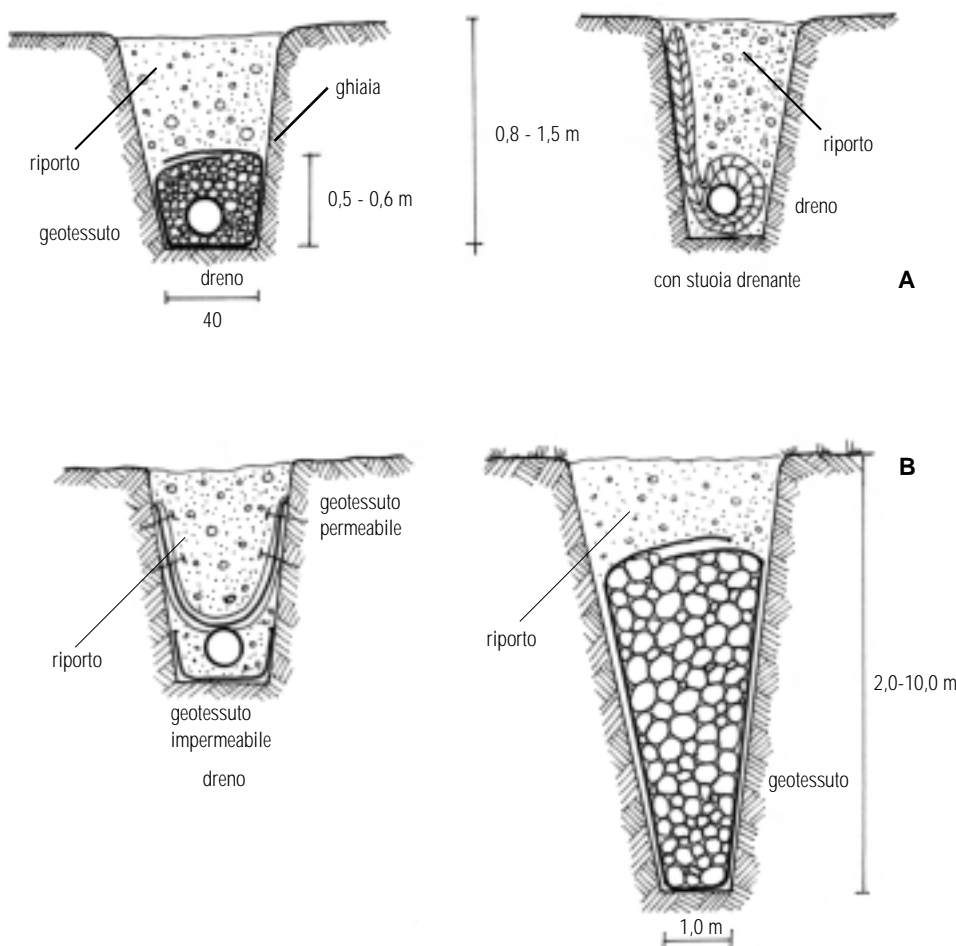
Tipologia di drenaggi tubolari (A): con geotessuto e ghiaia; con stuoie drenante, con fondo impermeabilizzato; e di trincee drenanti (B).
